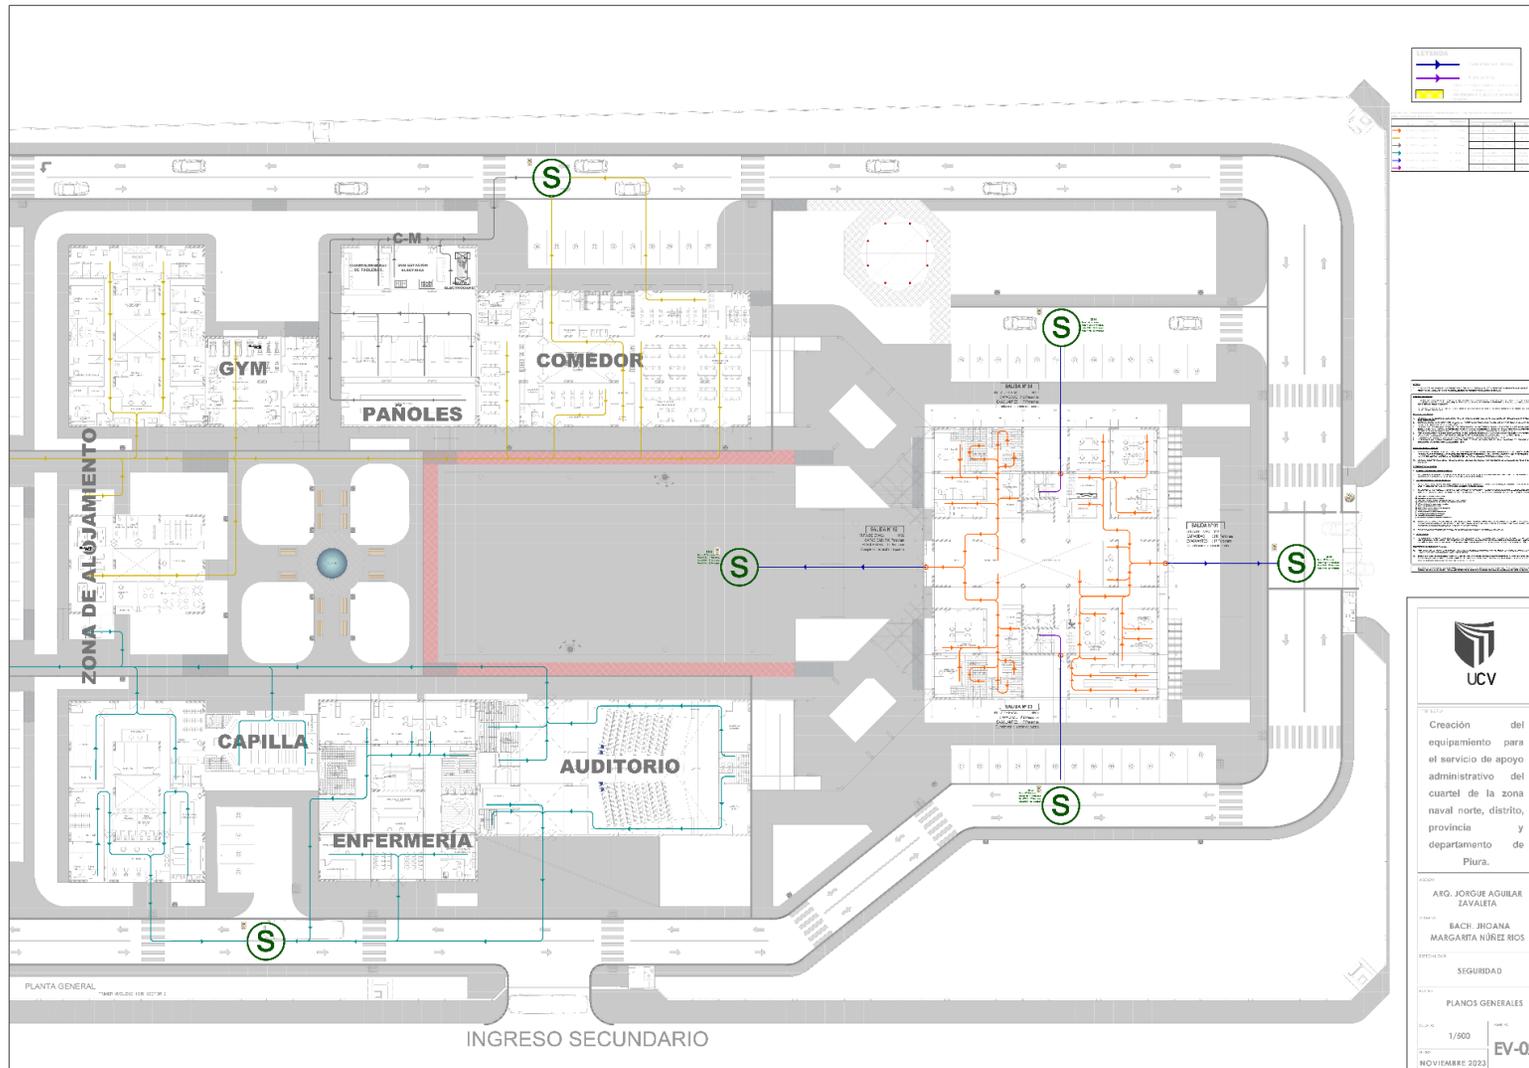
Planos Generales de Seguridad - Plano general – SECTOR 2
